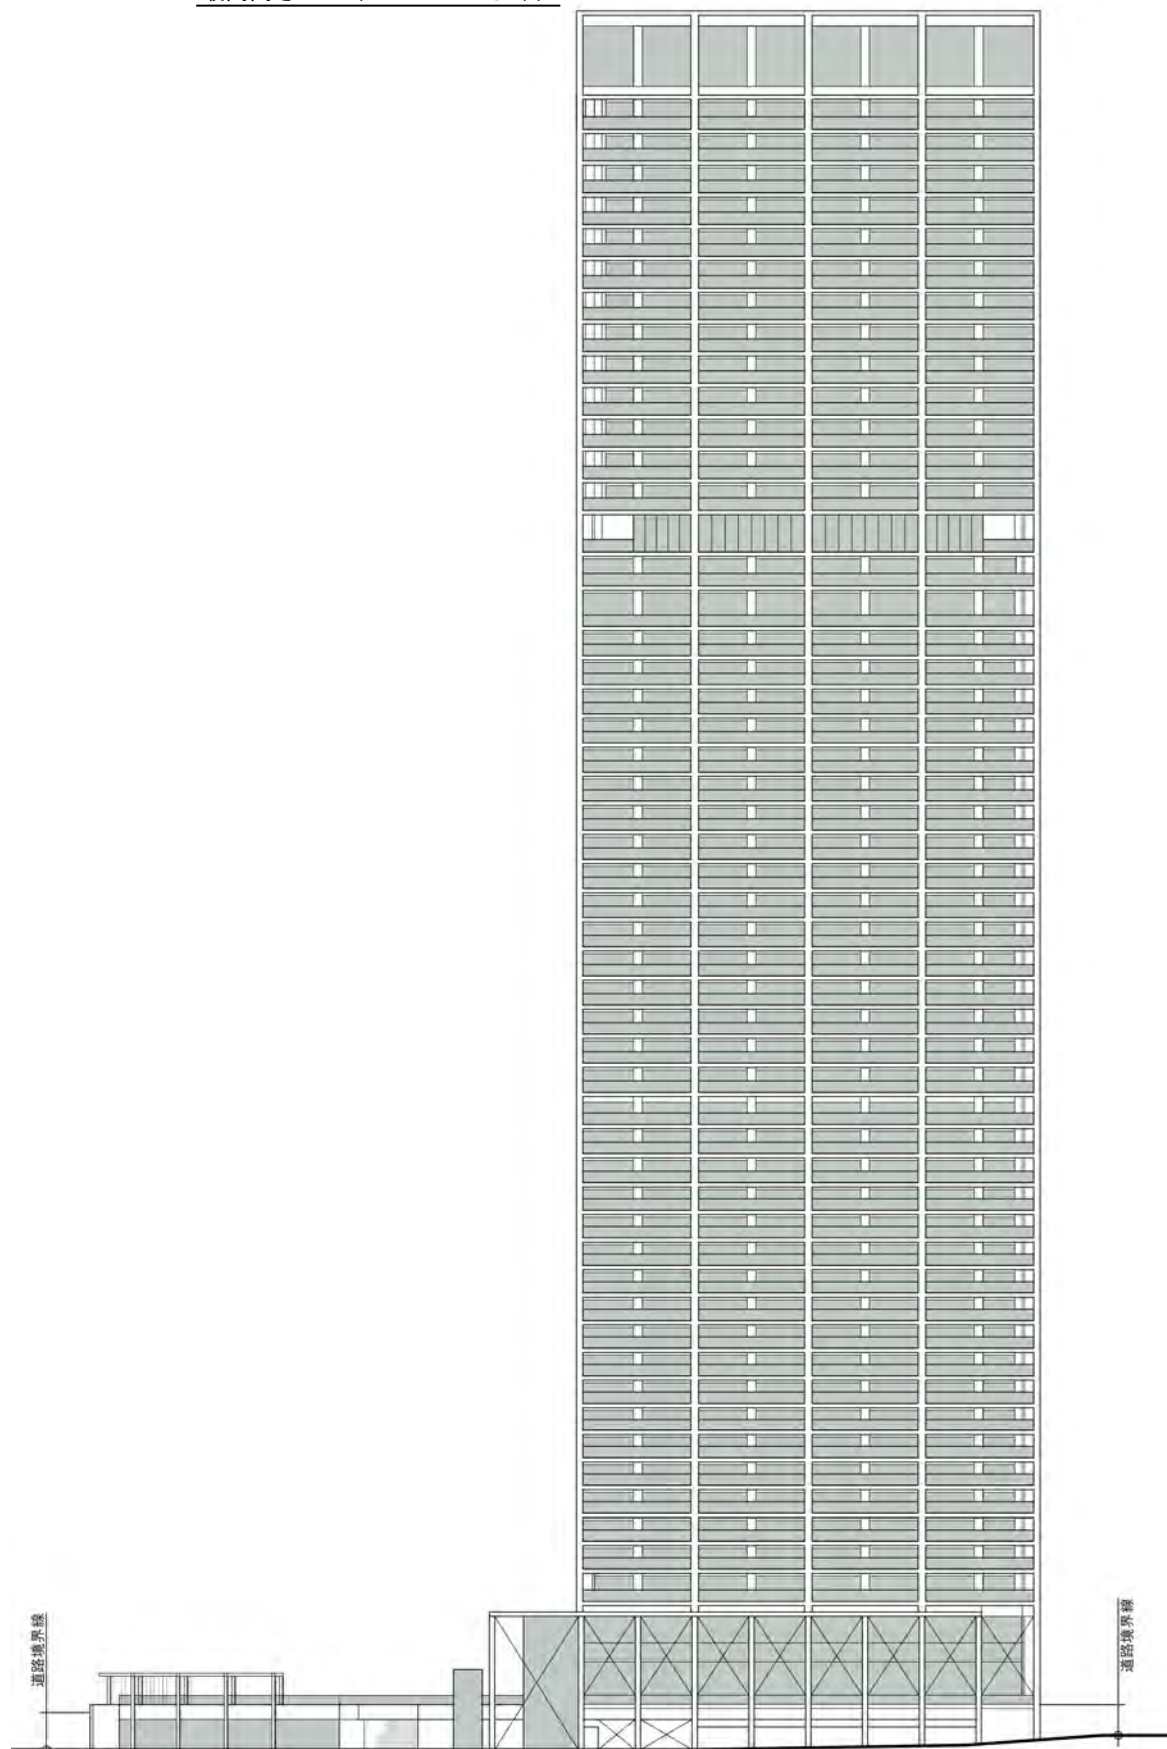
(3) 立面図 (東立面図 S=1:1,000) 【変更前】
